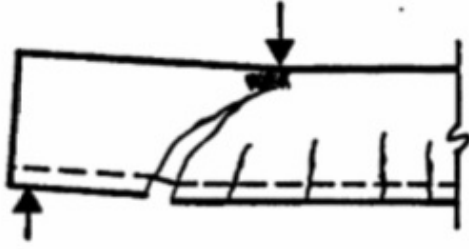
Kesme donatısı olmayan yüksek kirişte kesme kırılması [13]
